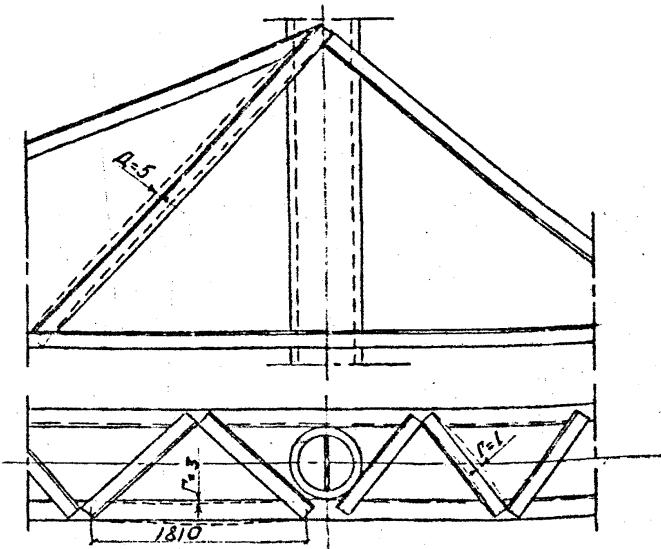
Допуски на сборку одностоечных анкерно-угловых железобетонных опор
